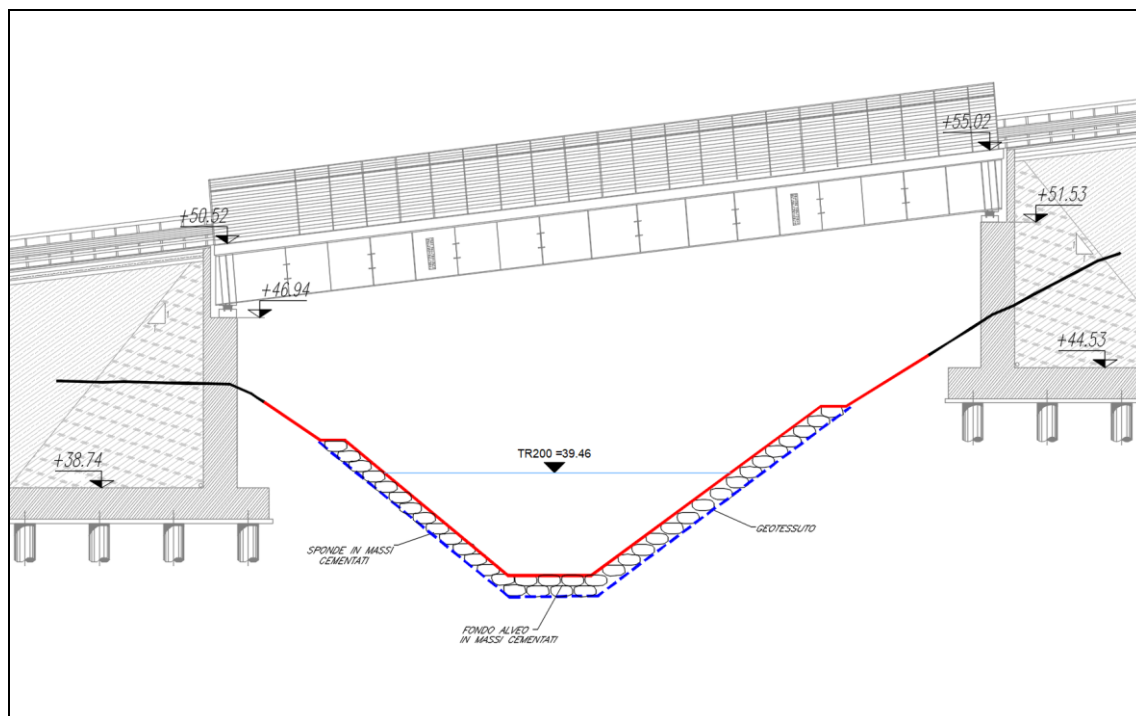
Sezione di sistemazione idraulica tipologica di progetto attraversamento Rio Aiveglia
